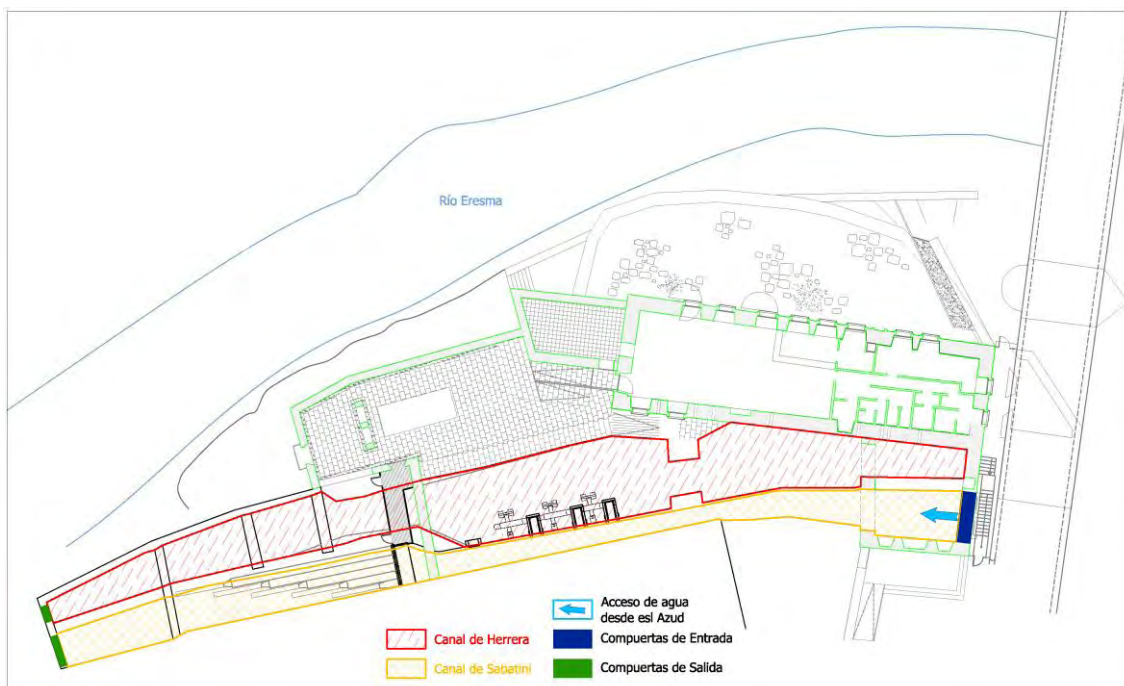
Vista en planta del sistema de canales actual (fuente: Excmo. Ayuntamiento de Segovia).
